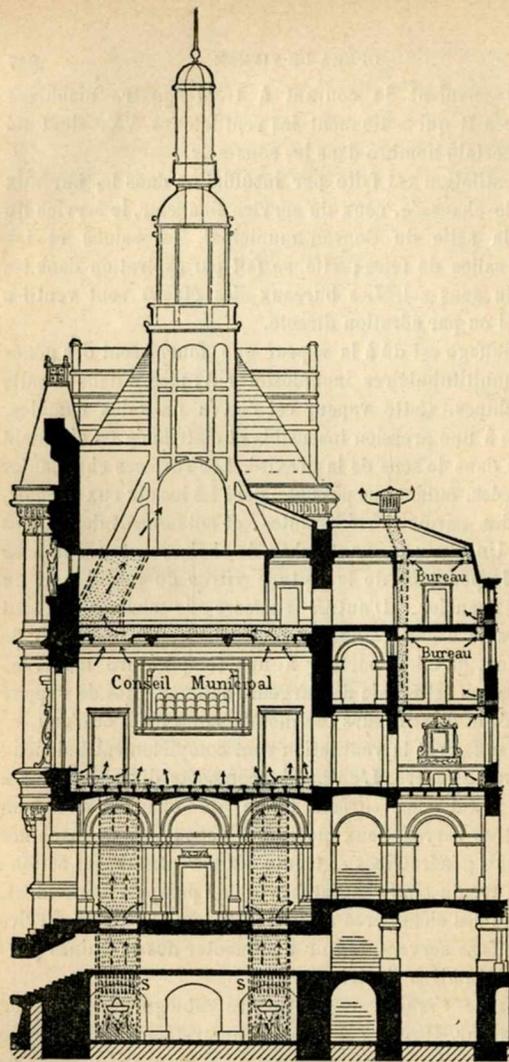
Hôtel de ville de Paris (coupe transversale, façade principale).
